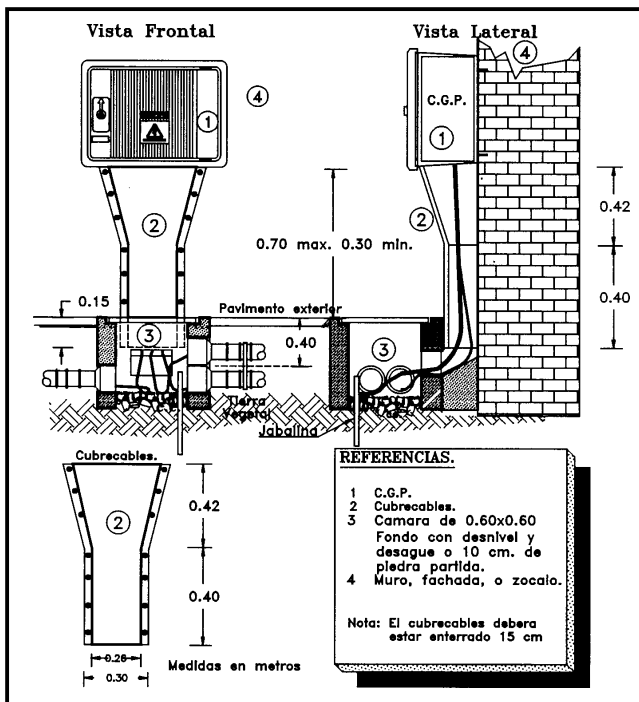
C.G.P. instalada de forma aparente y amurada dentro del retiro.
